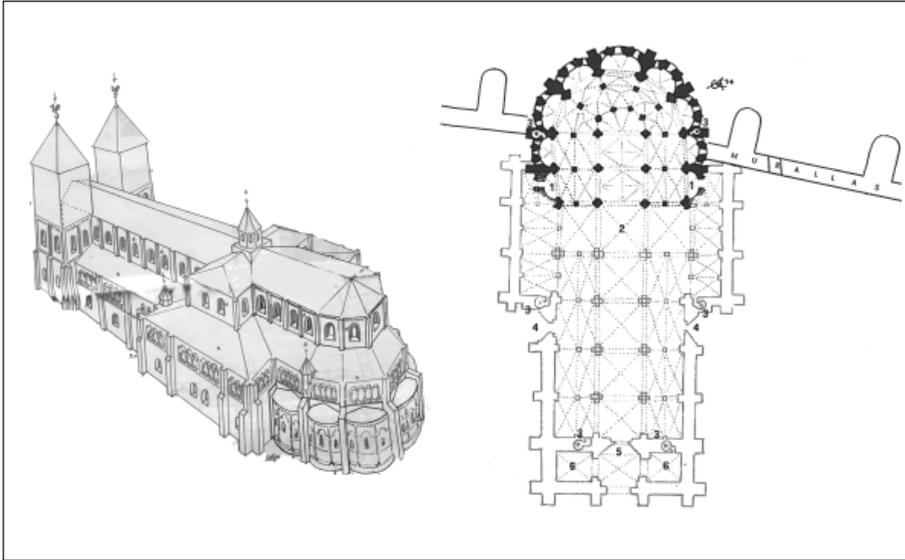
Reconstrucción en perspectiva y planta del proyecto de Fruchel (Rodríguez Almeida, 1974).
